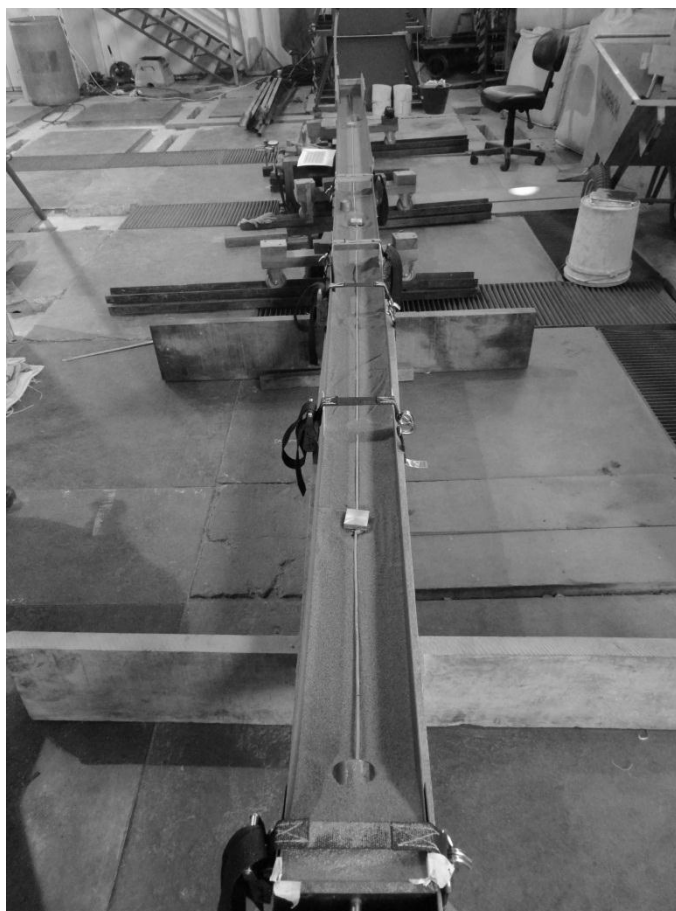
CONFIGURAÇÃO DO ENSAIO 4
